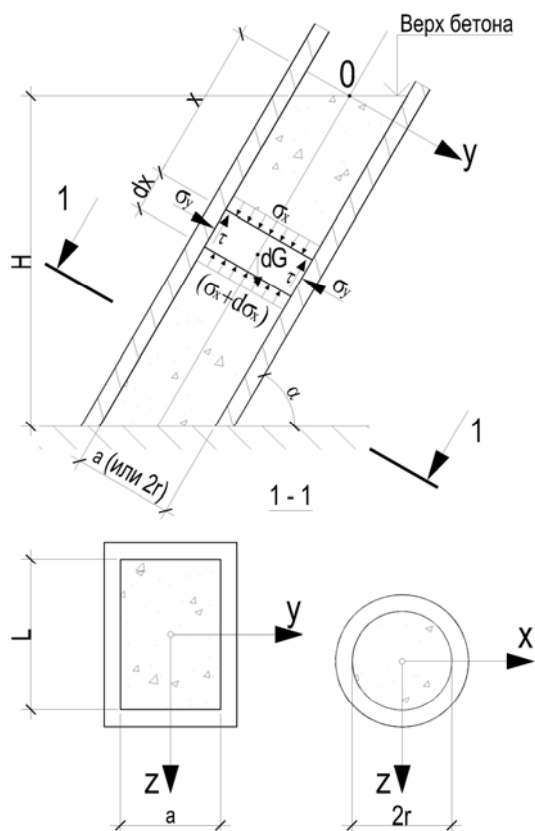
Расчетная схема для определения давления бетонной смеси на наклонную опалубку
